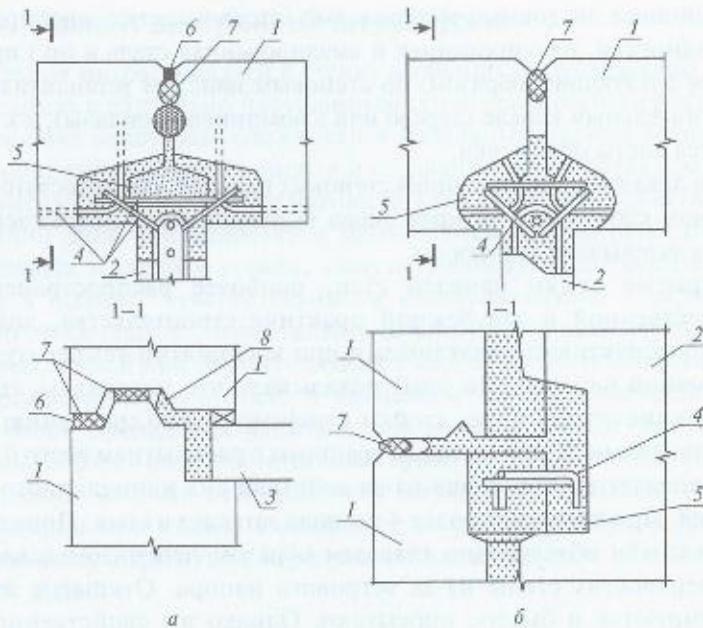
Схема герметизации панелей наружных стен крупнопанельных зданий:
